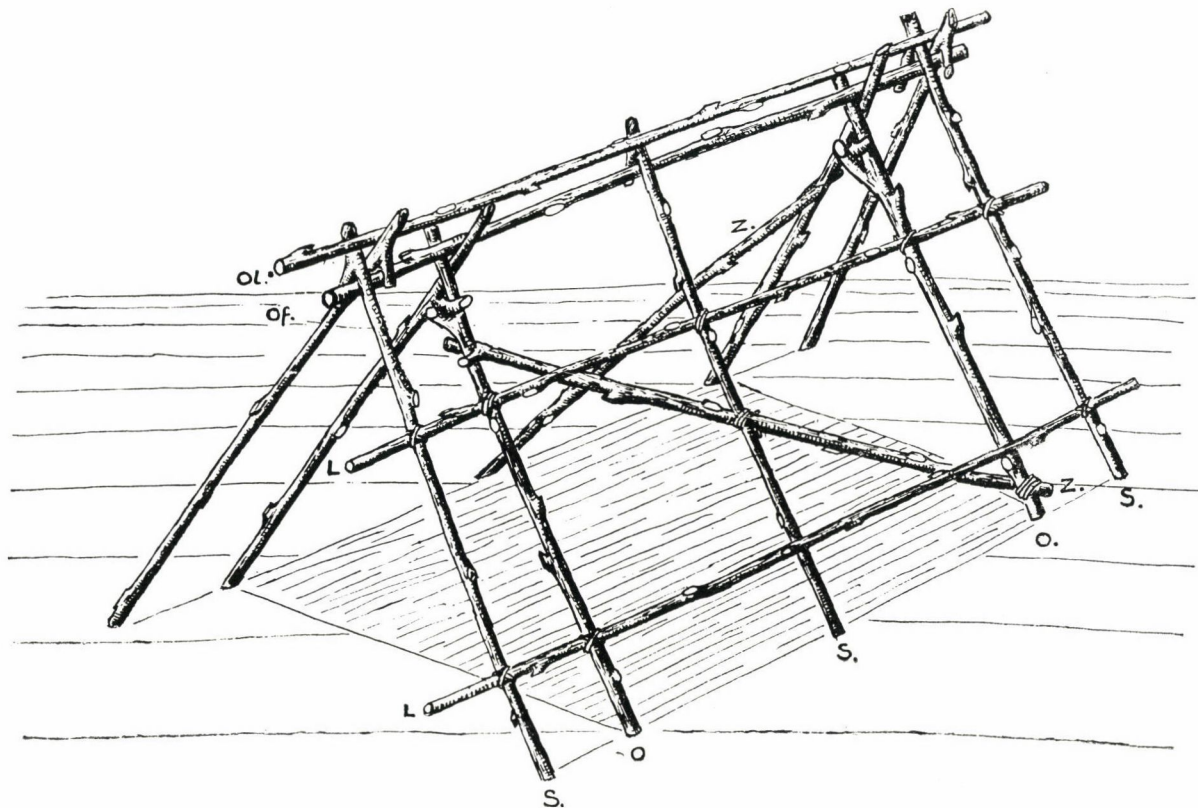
Rekonstruiertes Holzgerüst des Hauses «E»
